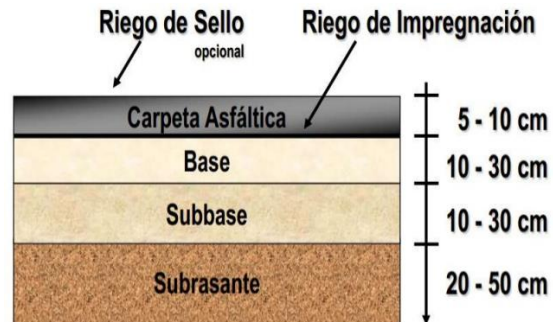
Sección Transversal de la Estructura de un Pavimento Flexible. Adaptado de Pavimentos Flexibles y Rígidos. [En línea]. Disponible en: <https://es.slideshare.net/nievesiita/pavimento-flexible-y-rigido>. [Consulta: 24-02-2018]
